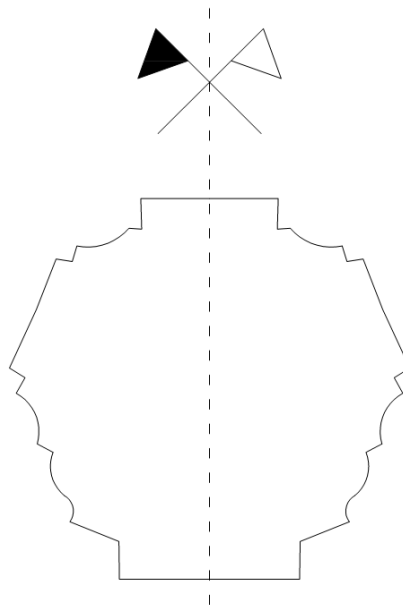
Sezione pilastro, avente un asse di simmetria
